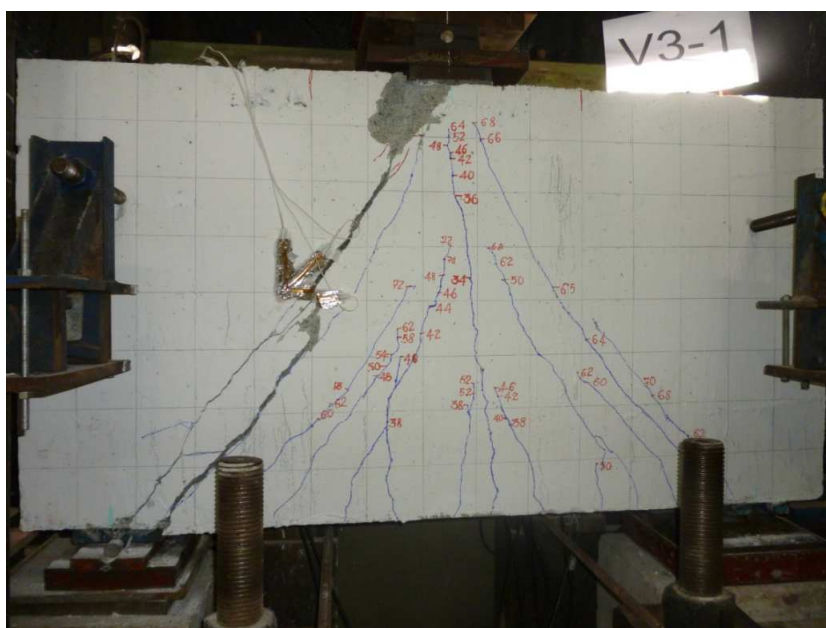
Configuração de fissuras - Viga V3-1.
